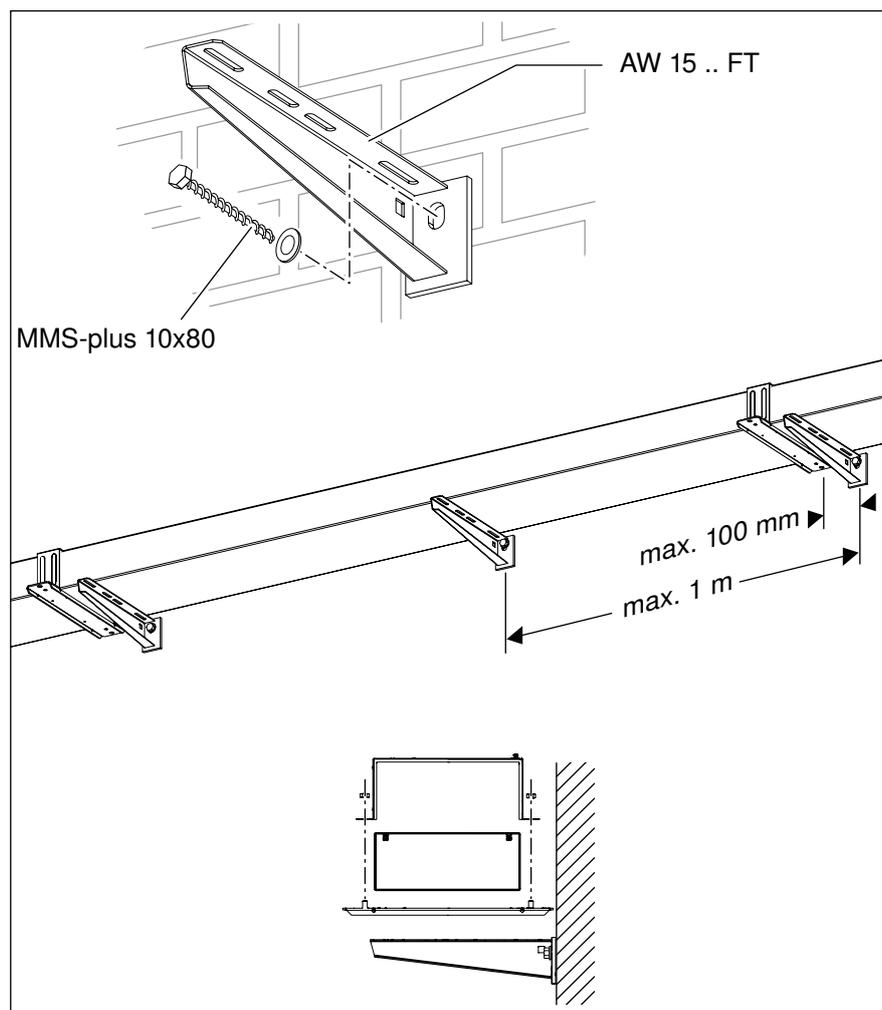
Beispiel für Streckenführung auf Wandauslegern
